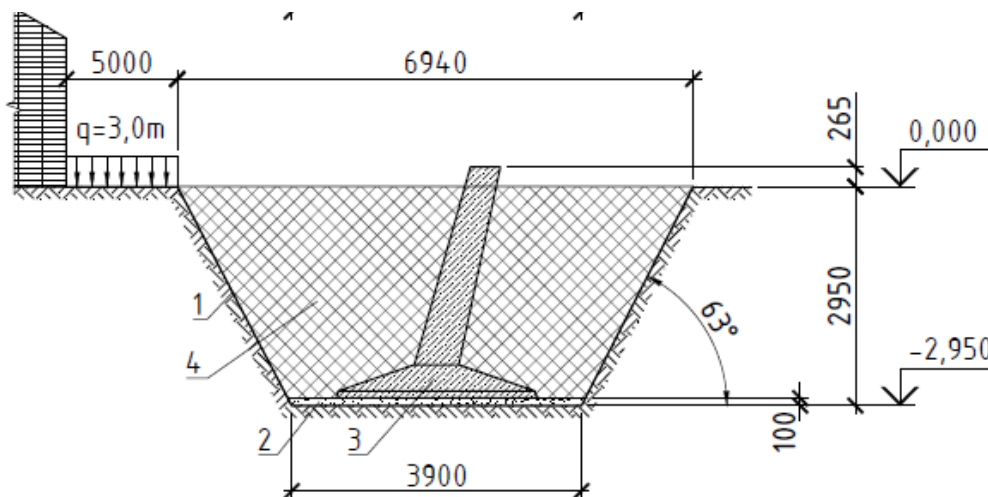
Геометрические параметры котлована для возведения фундамента опоры ЛЭП: 1 – естественные откосы котлована; 2 – песчаная подушка; 3 – столбчатая опора ЛЭП; 4 – грунт обратной засыпки
